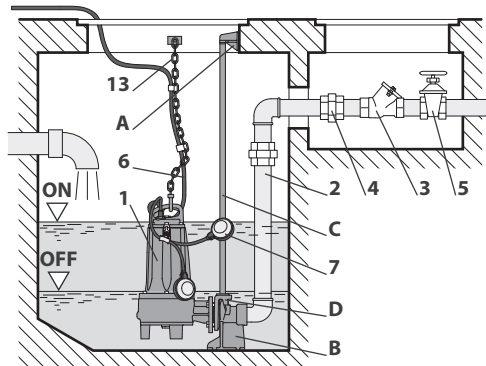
Instalação transportável de bomba com flutuador magnético.
